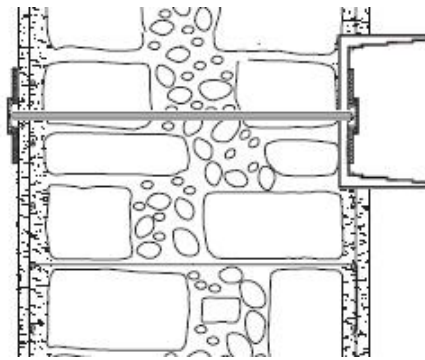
Fixação de um perfil metálico à parede e reforço de apoio com encamisamento. Adaptada (Coias [6])
